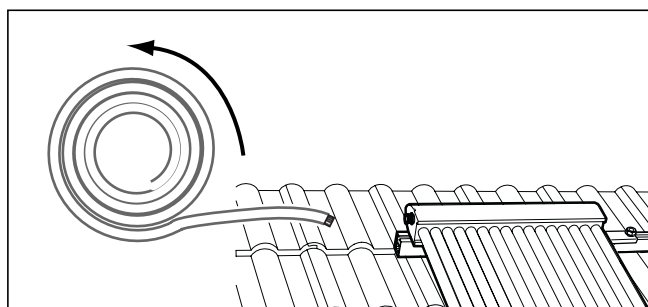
Dérouler et poser le tube solaire flexible sur place.
